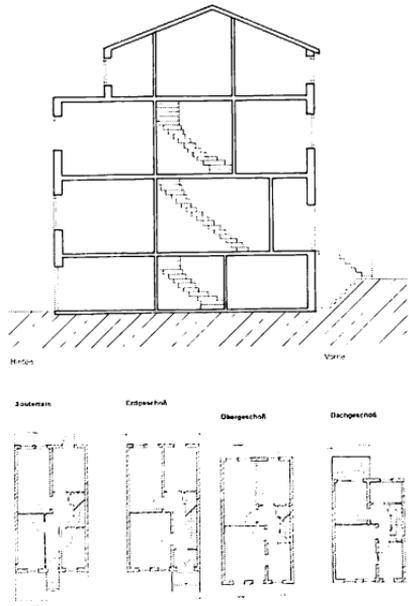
Schnitt durch ein Bremer Haus und Grundrisse der Etagen
